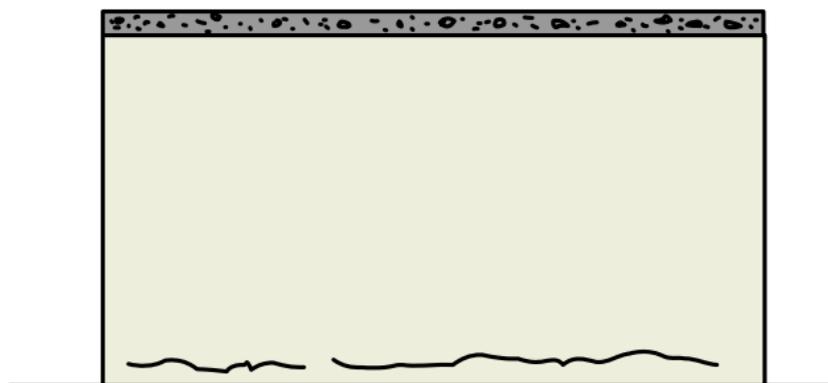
Configuração típica de fissura causada por movimentação higroscópica (SOUZA, 2008)
